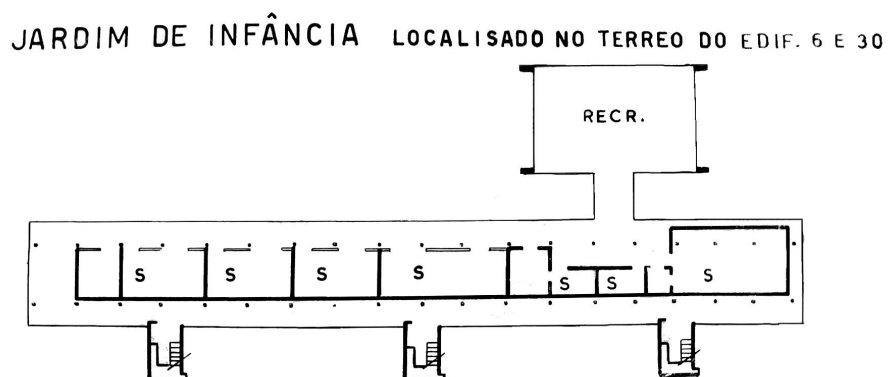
Planta dos Jardins de Infância. Fonte: Arquivo INSS.
